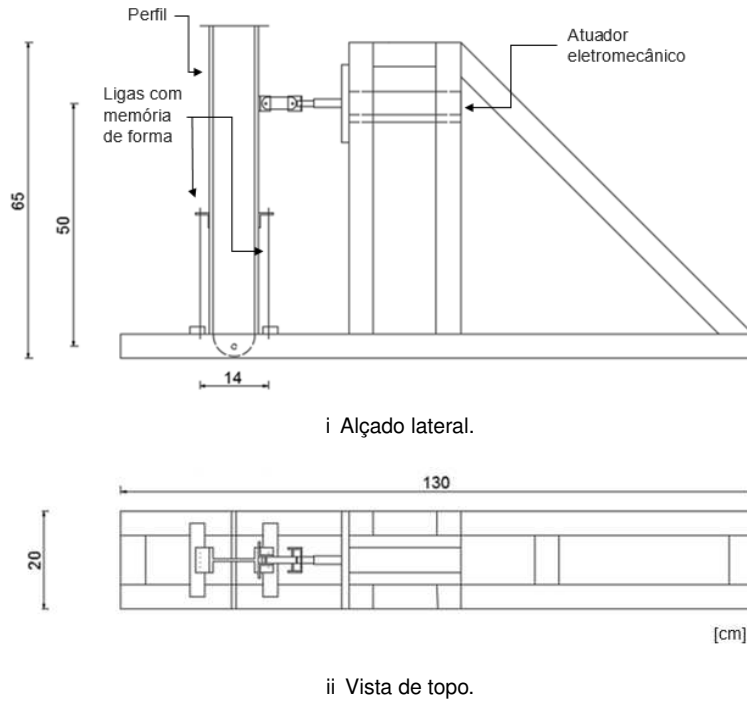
Ligação alternativa proposta e estrutura de ensaio.
